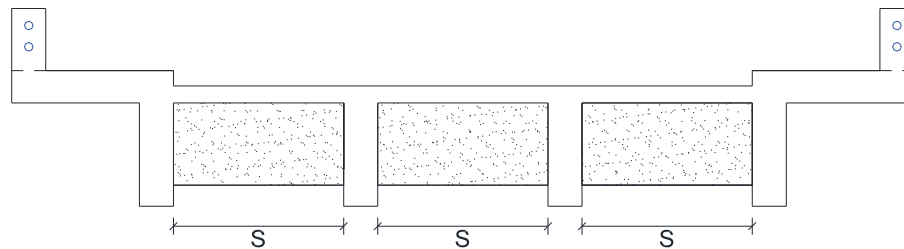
Longitud efectiva para secciones transversales de puentes de hormigón armado.
